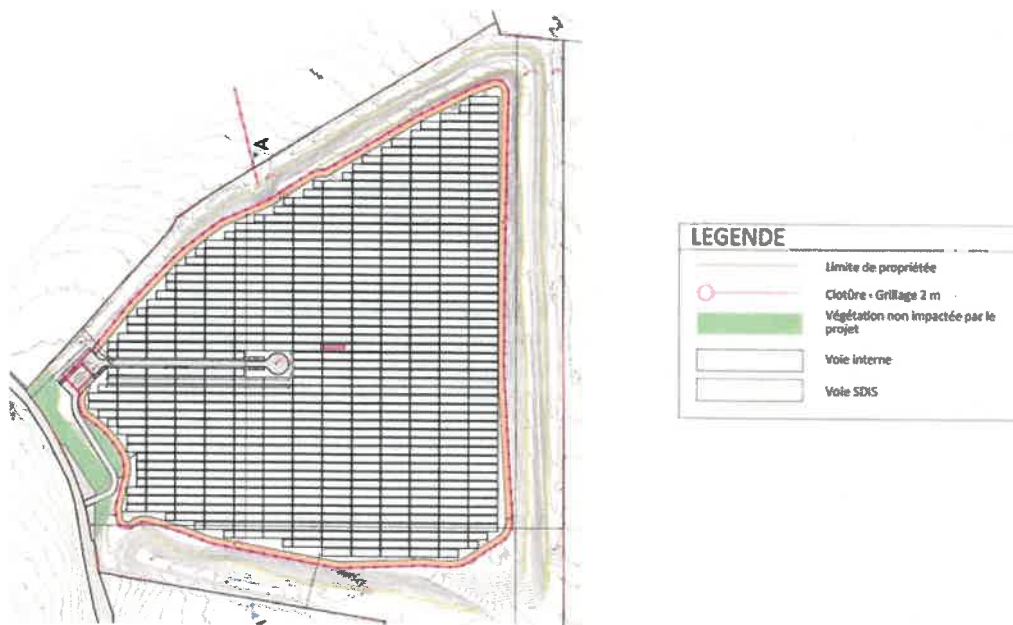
Plan d'implantation de la centrale photovoltaïque
